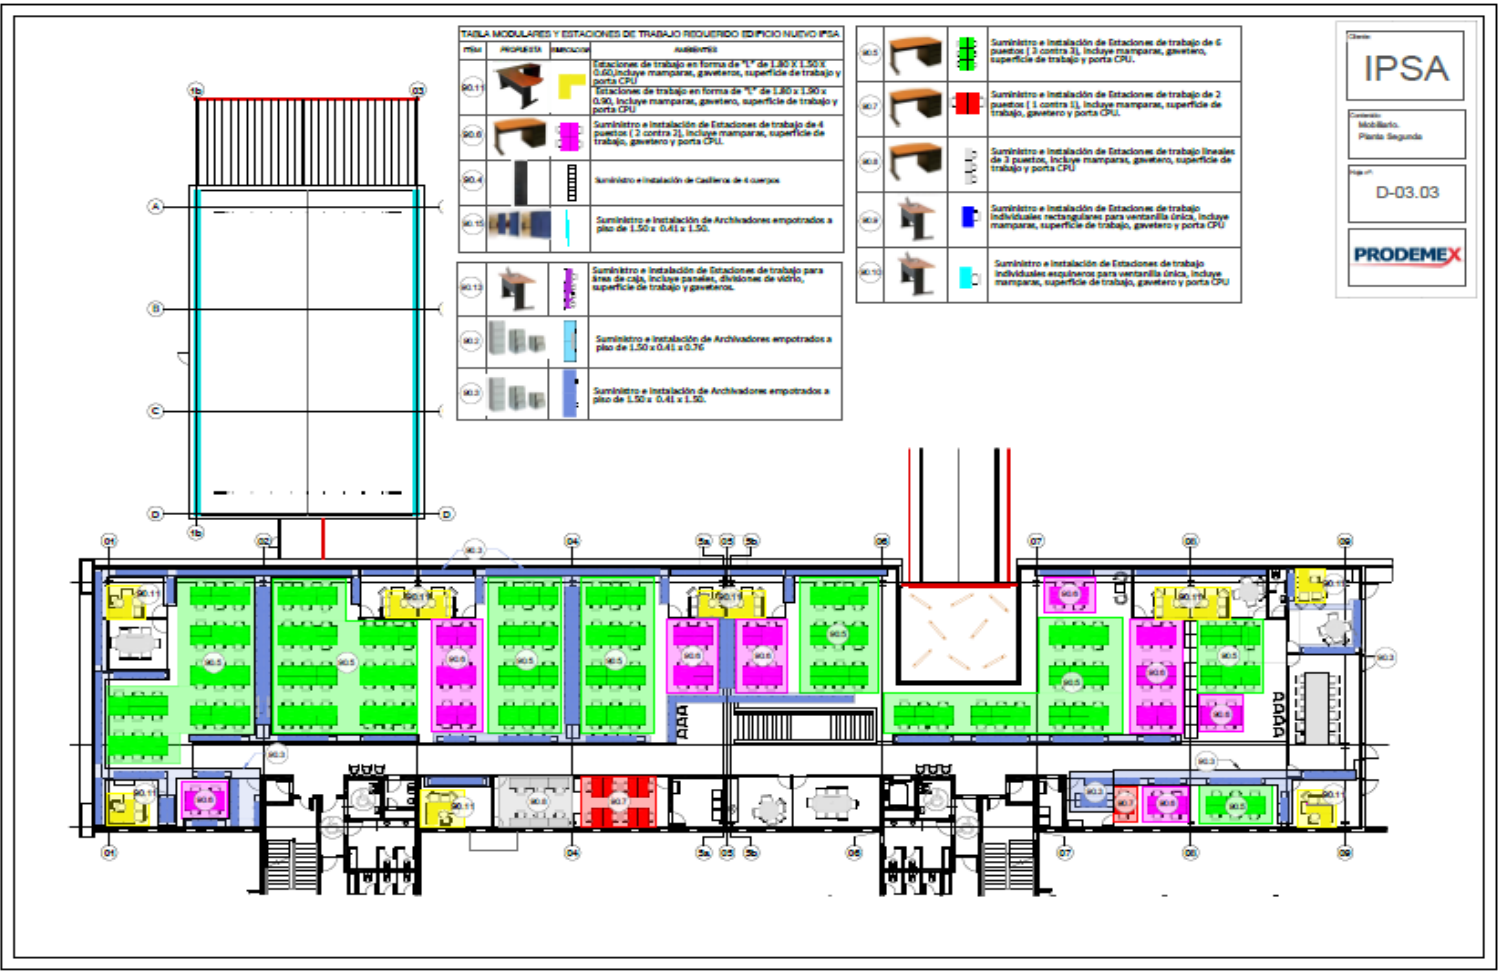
Lamina planta arquitectónica de muebles 1era planta
